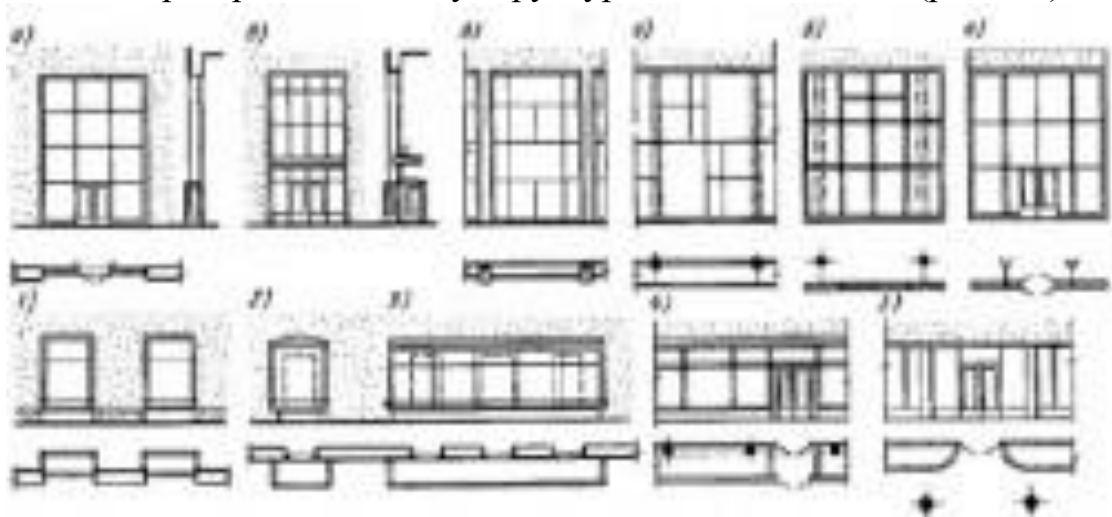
Типы витражей и витрин: а, б — витраж в проеме стены, в — то же, между утепленными колоннами каркаса, г — то же, раздельный с размещением наружного остекления перед колоннами, д — то же, со спаренным переплетом перед колонной, е — то же, с самостоятельными элементами жесткости, 1 — витрина-окно, 2, 3 — витрина приставная, 4 — витрина встроенная, 5 — то же, за колоннами каркаса
